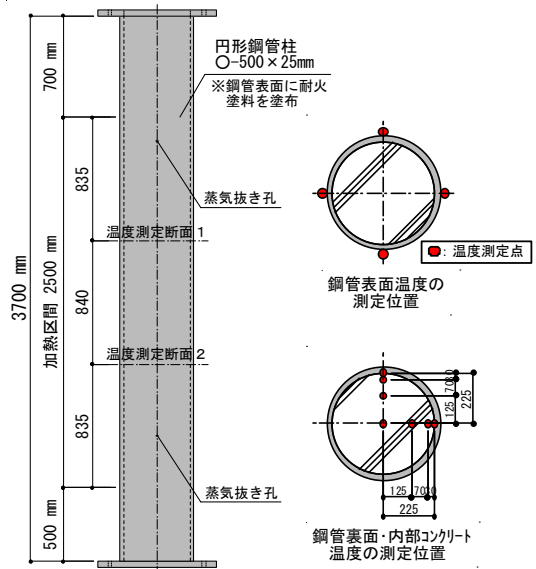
試験体の形状寸法 (載荷加熱実験) Configuration of Specimens
